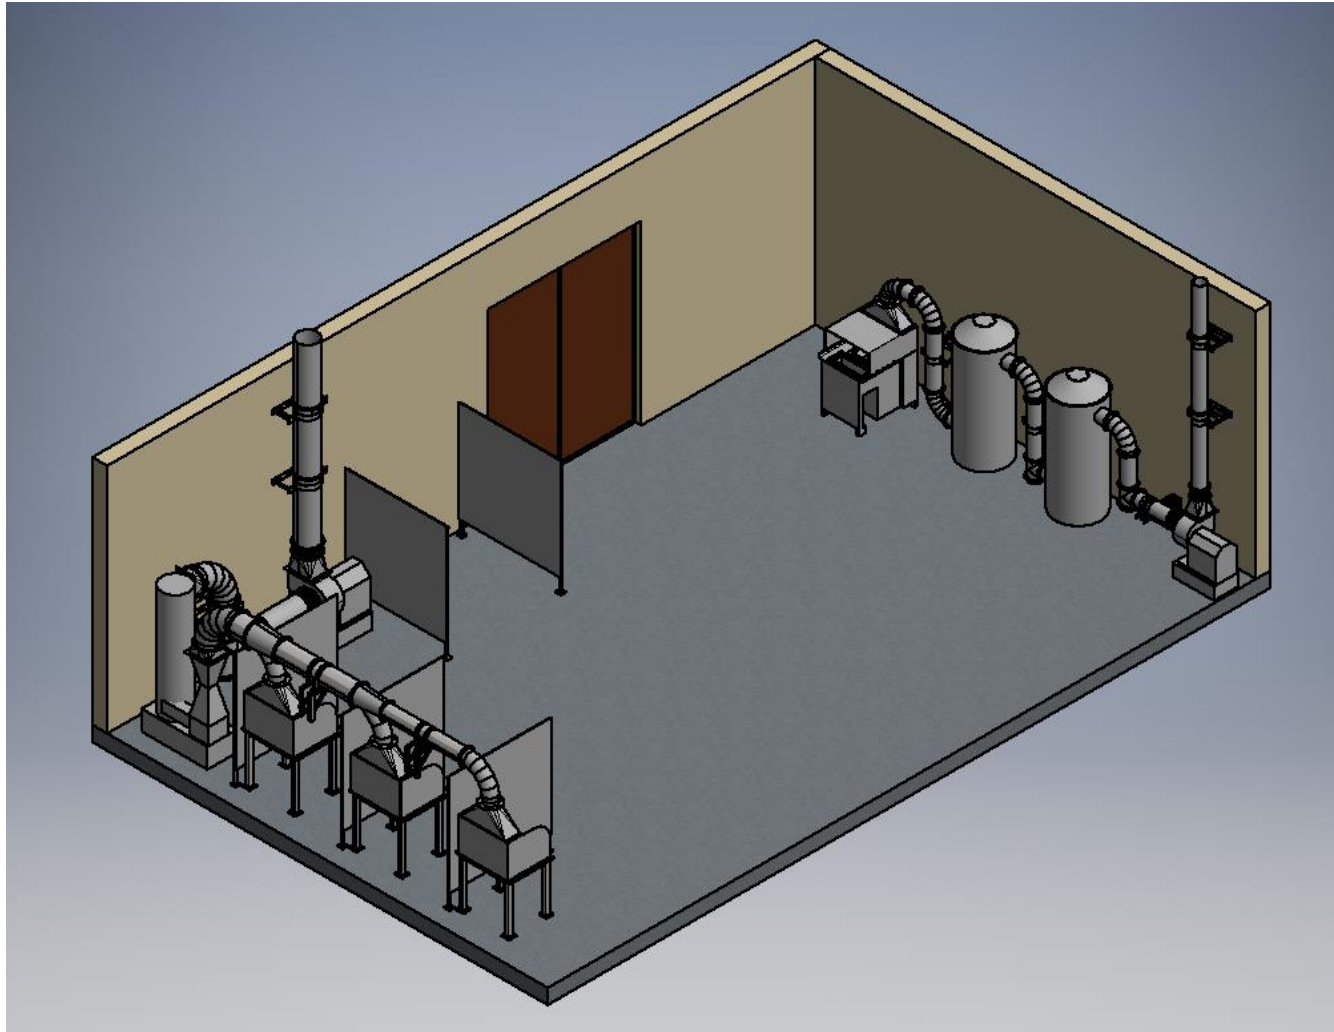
Disposición de los sistemas de extracción en la Zona de Soldadura y Forja del Laboratorio de Manufactura.
